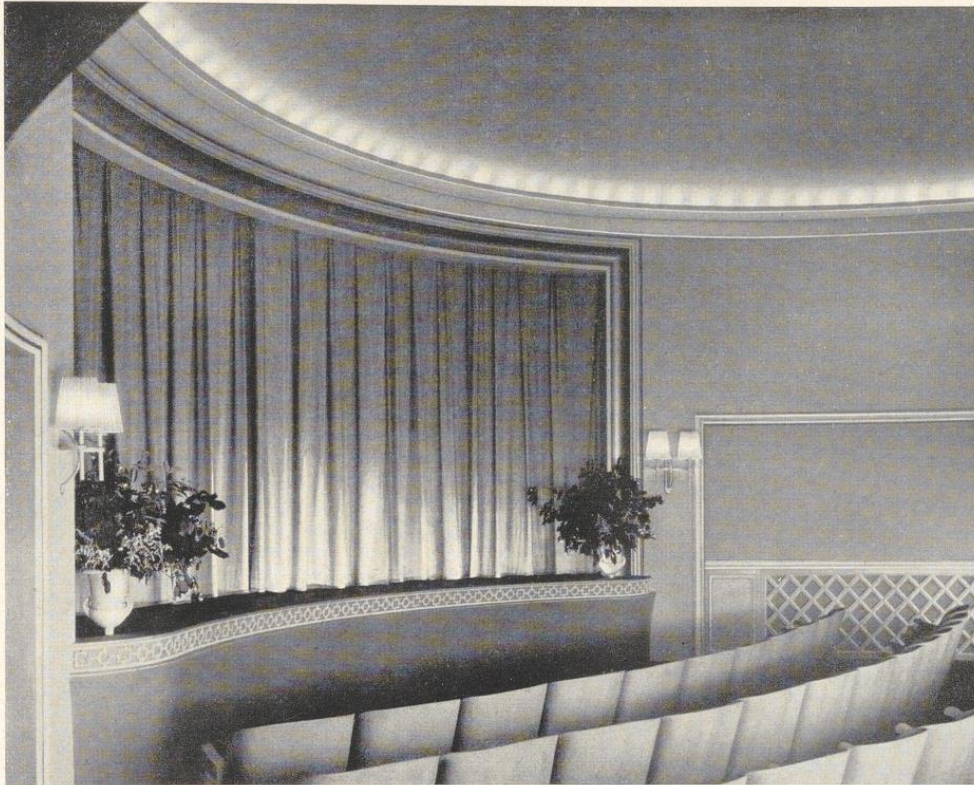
Atlantis-Lichtspiele in Bremen mit einer Flachkuppel in Rabitz, an Betondecke aufgehängt. Lichtpfanne unter der Decke, Bühnenumrahmung und Wandverzierung in Stuck gezogen. Entwurf Architekt Martin Zill, Bremen. Ausführung Lüning u. Sohn, Bremen
